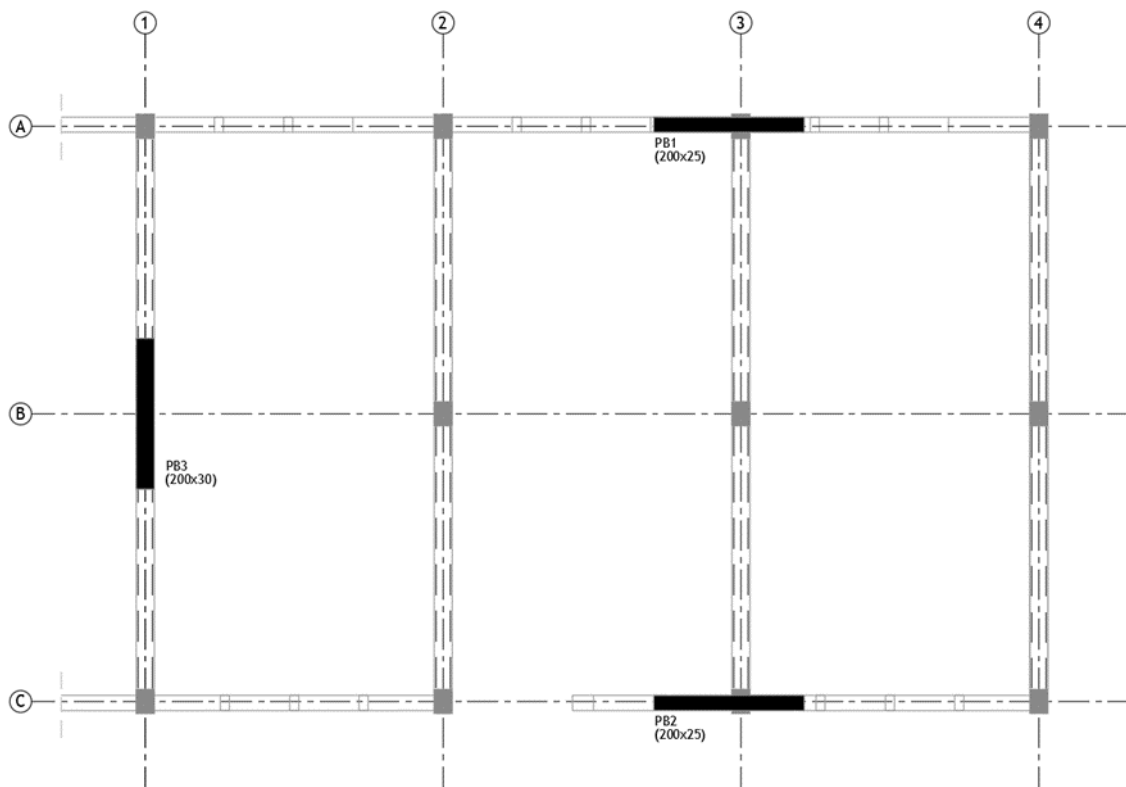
Planta de R/Chão com solução de reforço com introdução de parede resistente (solução2)
